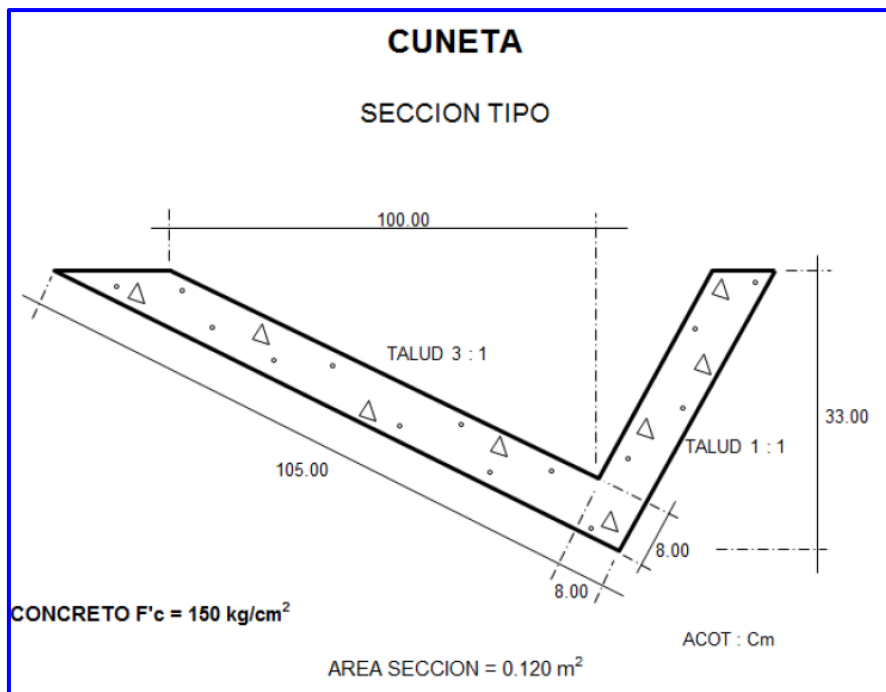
SECCIÓN TIPO DE UNA CUNETAS QUE SERÁN CONSTRUIDAS PARA CONducir LOS ESCURRIMIENTOS
